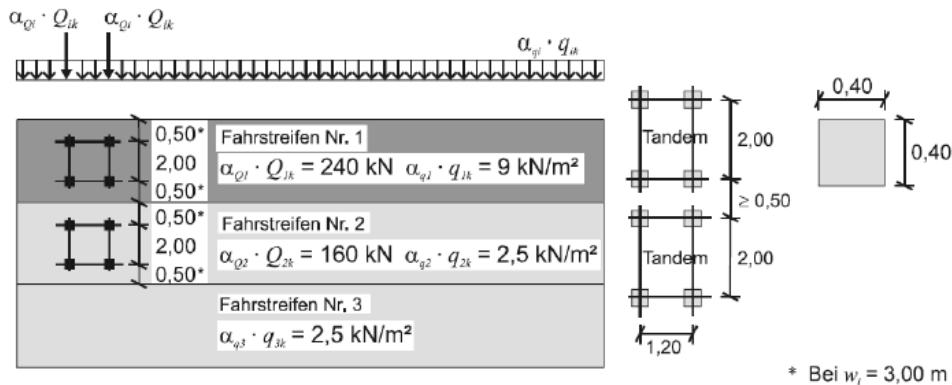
Lastmodell 1 (angepasste Grundwerte)
